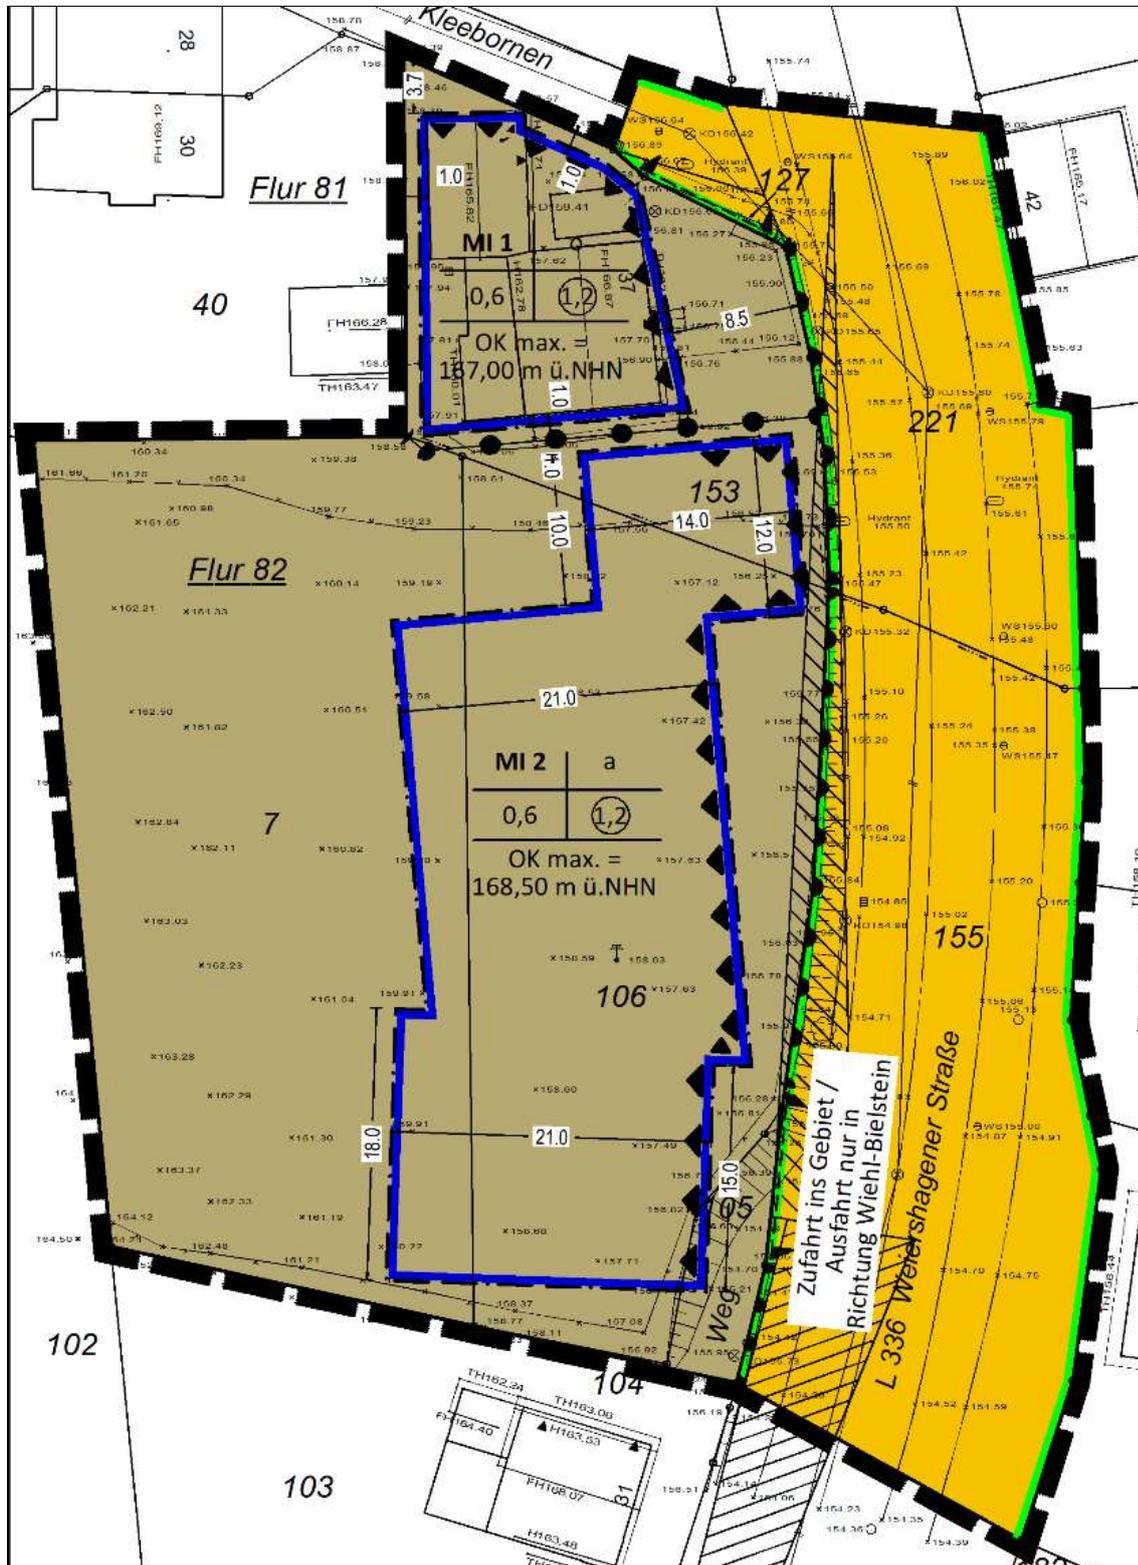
Entwurf Bebauungsplan, ohne Maßstab
